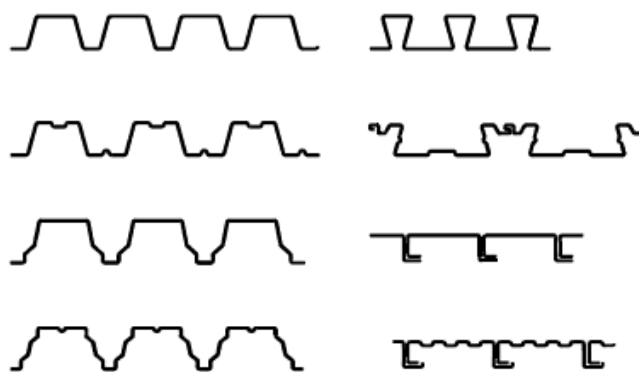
Chapas de aço enformadas a frio para aplicação em lajes como cofragem colaborante na solução construtiva em LSF (Veríssimo, 2008)
